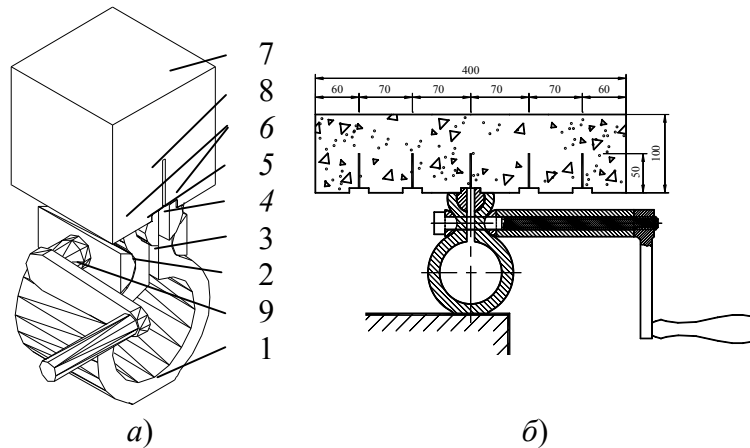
Портативное устройство для равновесного разрушения при двухточечном изгибе:
